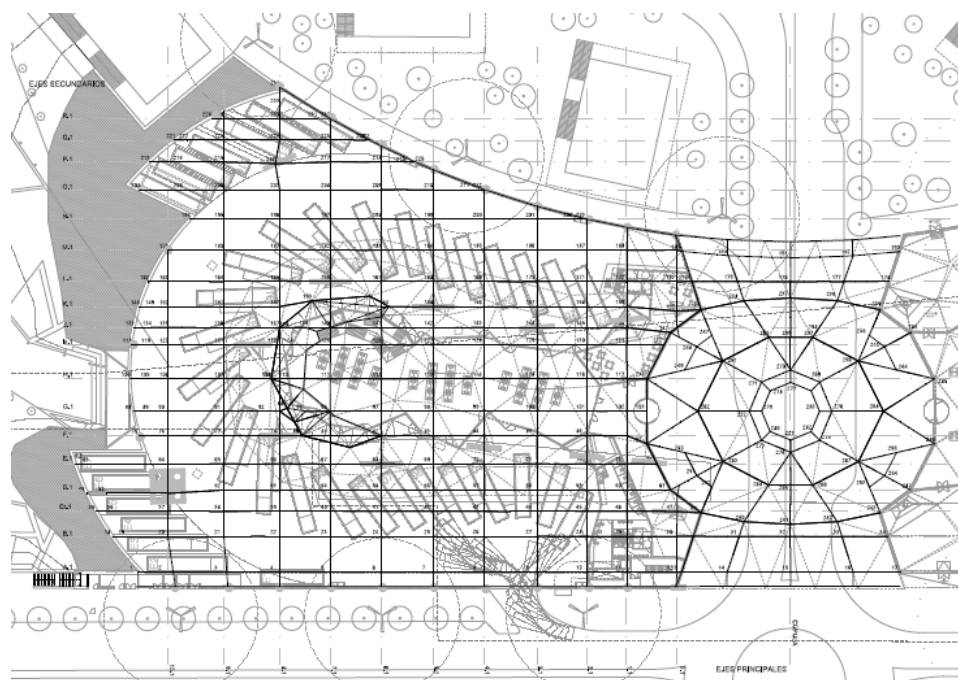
Planta de la estructura proyectada. Proyecto de Construcción
